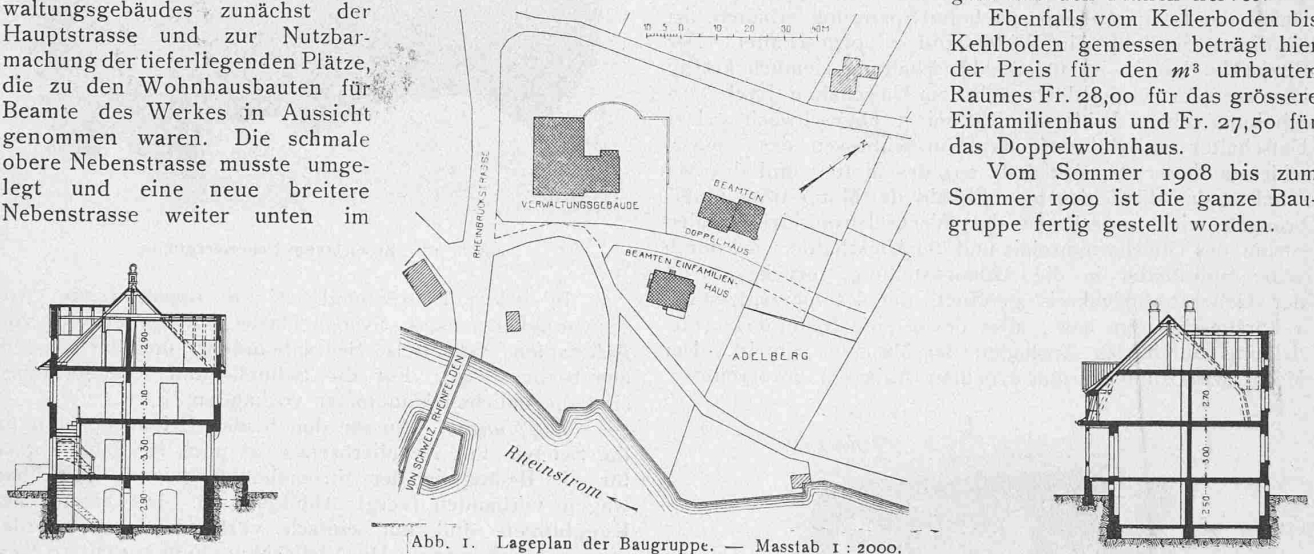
Lageplan der Baugruppe. — Masstab 1 : 2000.
